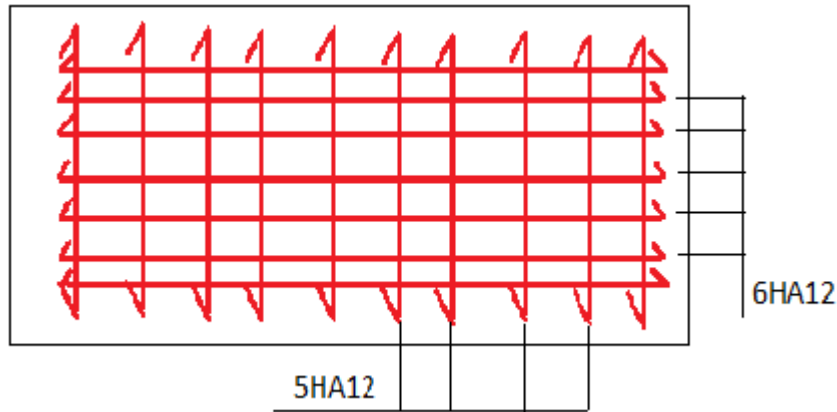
Schéma de Ferrailage de Semelle filante
